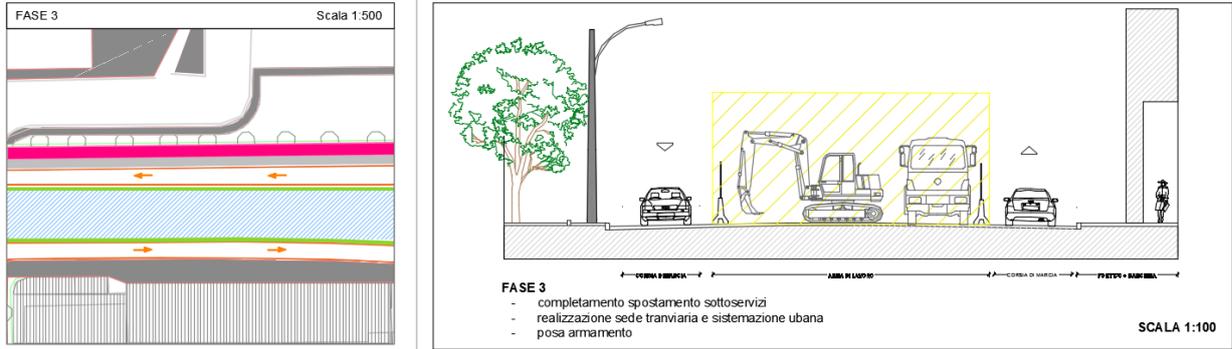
Tipologico cantiere con sede centrale Fase 3
